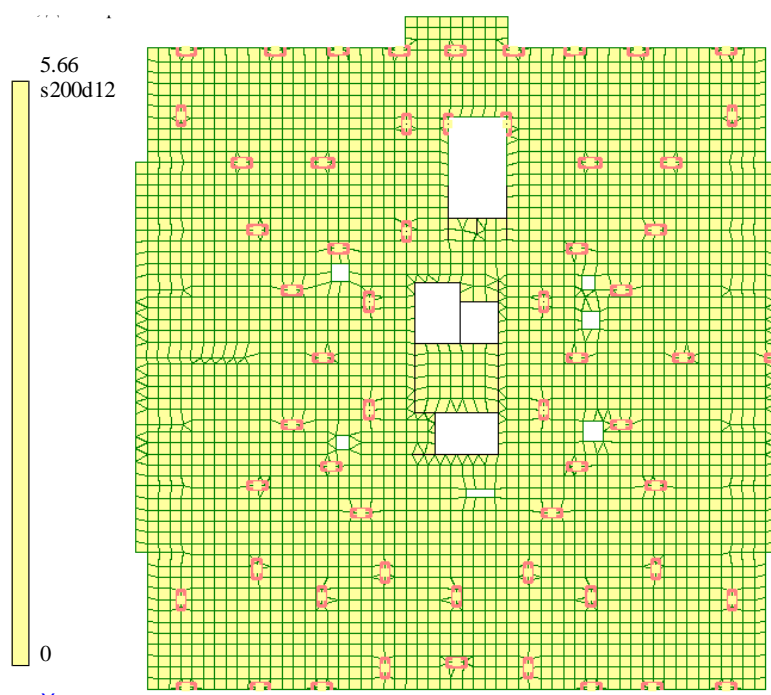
Площадь арматуры на 1 п.м. по оси X у нижней грани
